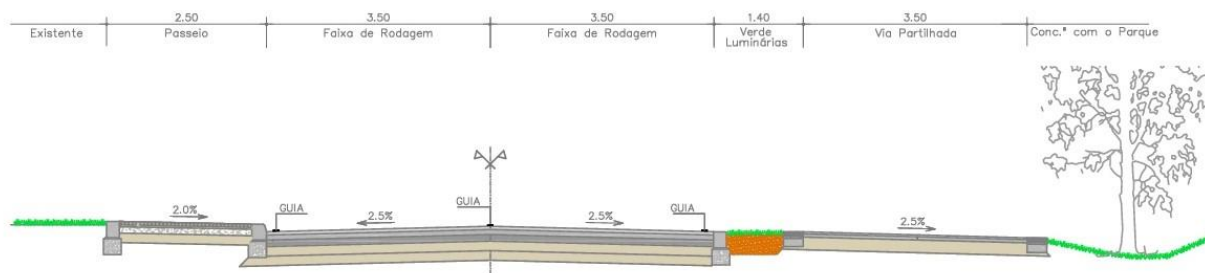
Perfil transversal tipo da Rua 4 da VCU.
